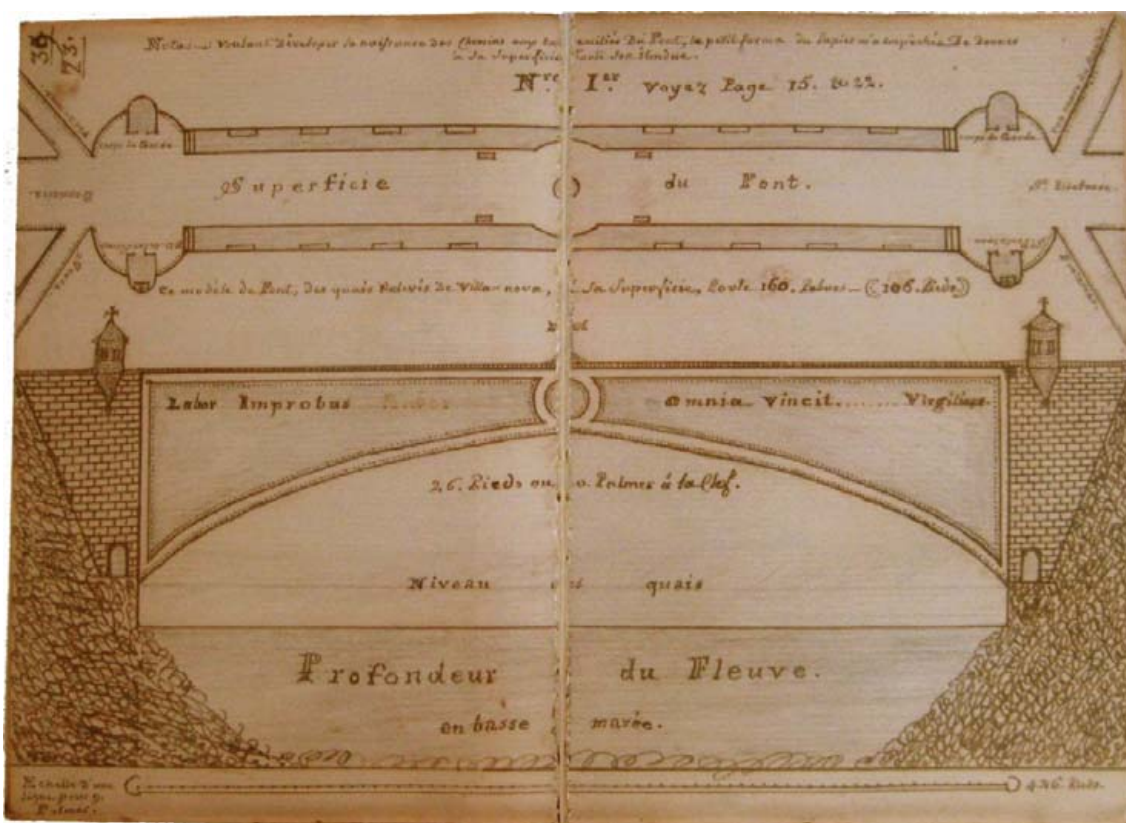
, Noël-Antoine Apuril du Pontreau, [Pont de pierre à construire sur le Douro à Porto], 18 de Dezembro de 1804, in AVRIL, Gilles, *L'Anti-Napoléon. Mémoires et papiers inédits du chanoine Apuril du Pontreau*, Paris, Editions de la Fondation Napoléon, Nouveau Monde Editions, 2006, II e III.
